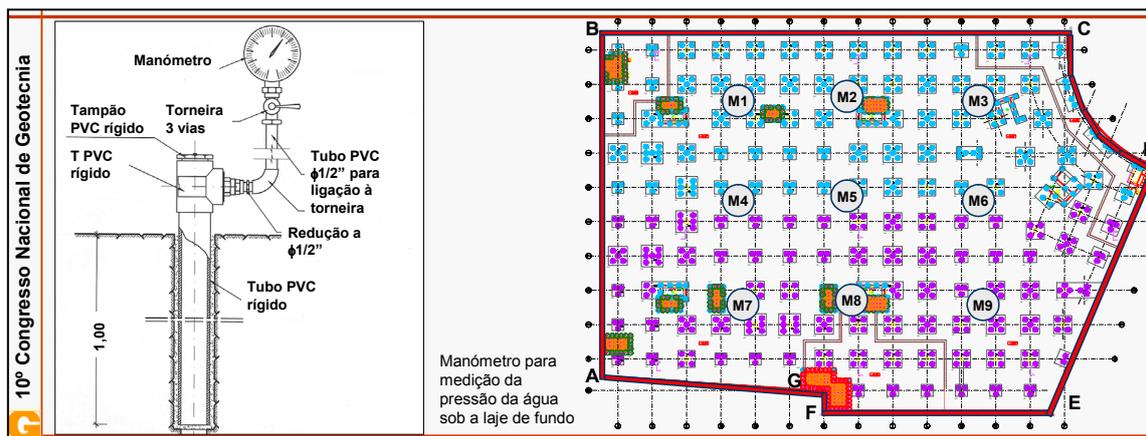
PIO: pormenor e localização dos manómetros para medição da pressão da água
